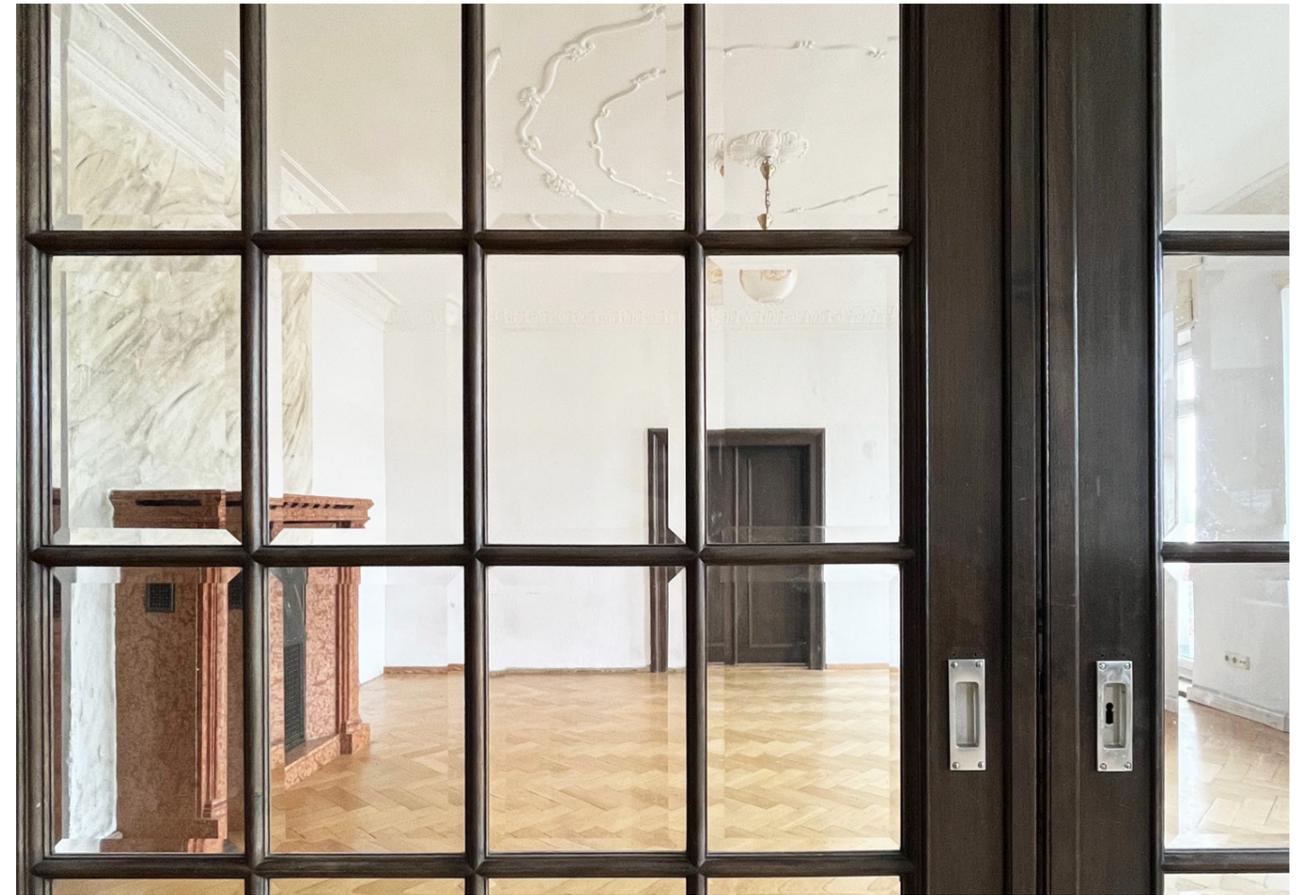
Blick durch Schiebetüre in Nebenzimmer, 1. Obergeschoss
